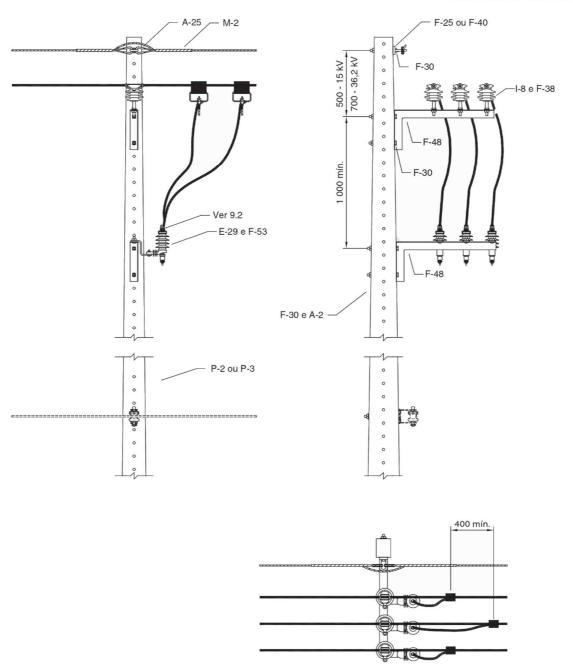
Estrutura CE2 PR - Poste de concreto de seção DT ou de madeira
